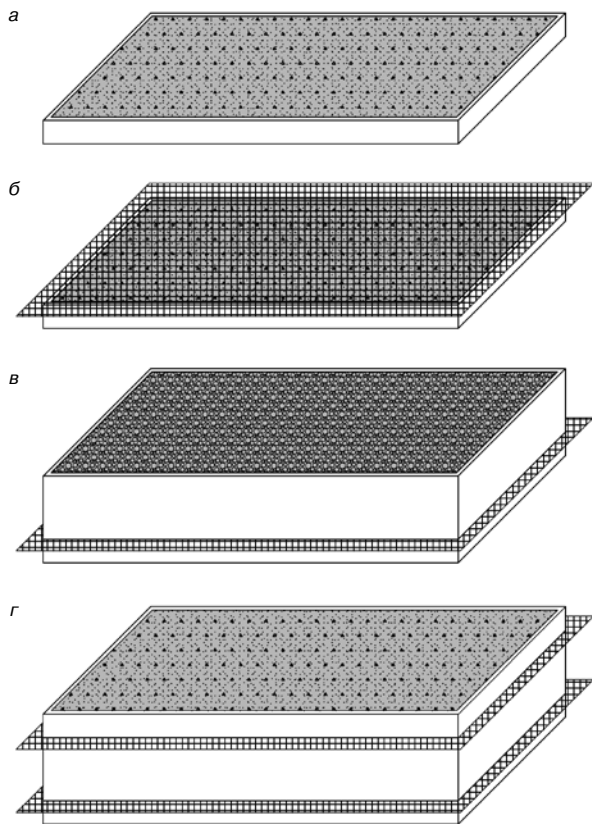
Технологическая последовательность изготовления многослойной строительной панели: а – укладка и уплотнение наружного конструкционного слоя; б – укладка стеклосетки на границе слоев; в – наращивание опалубки, укладка и уплотнение теплоизоляционного слоя; г – укладка стеклосетки по поверхности теплоизоляционного слоя, наращивание опалубки, укладка и уплотнение конструкционного слоя
